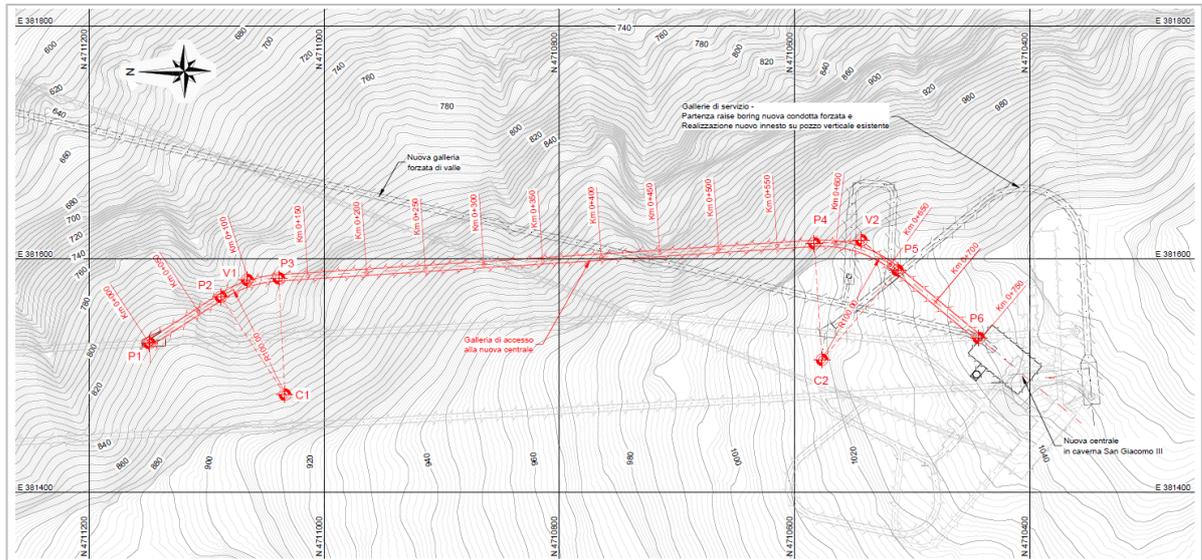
Galleria di accesso alla nuova centrale in caverna – pianta
